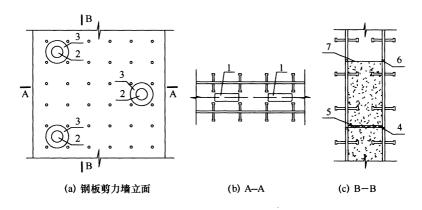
混凝土灌浆孔、流淌孔、排气孔和排水孔设置 1-灌浆孔;2-流淌孔;3-加强环板;4-排气孔;5-横向隔板;6-排水孔;7-混凝土浇筑面
